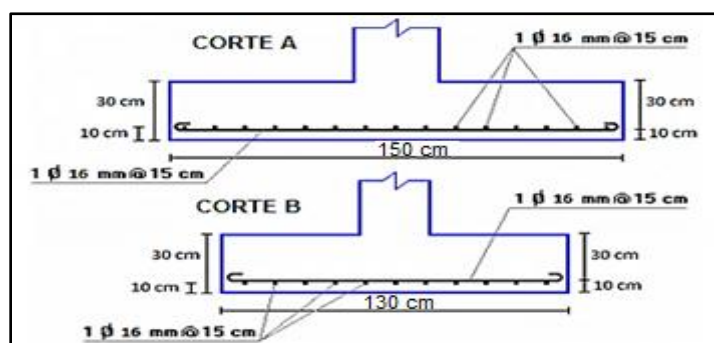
Armado de varillas en la dirección x-y corte A-B.
